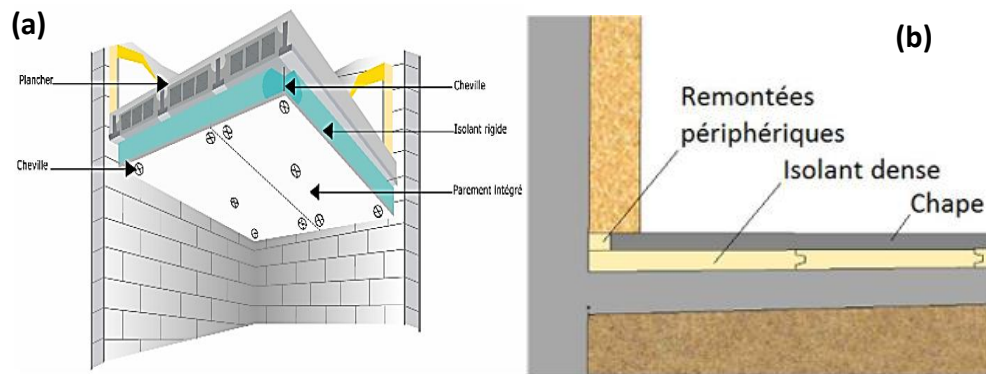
Isolation de plancher : (a) sur vide-sanitaire, (b) Plancher sur terre-plein [47]
